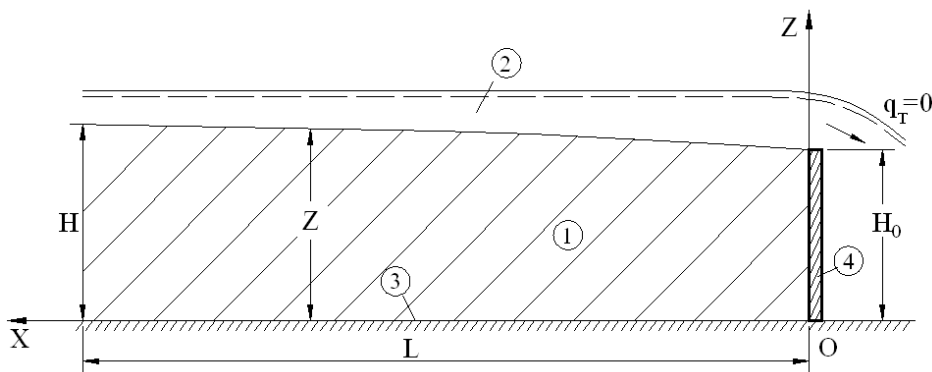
Схема устойчивого положения грунтовой среды в продольном разрезе:
